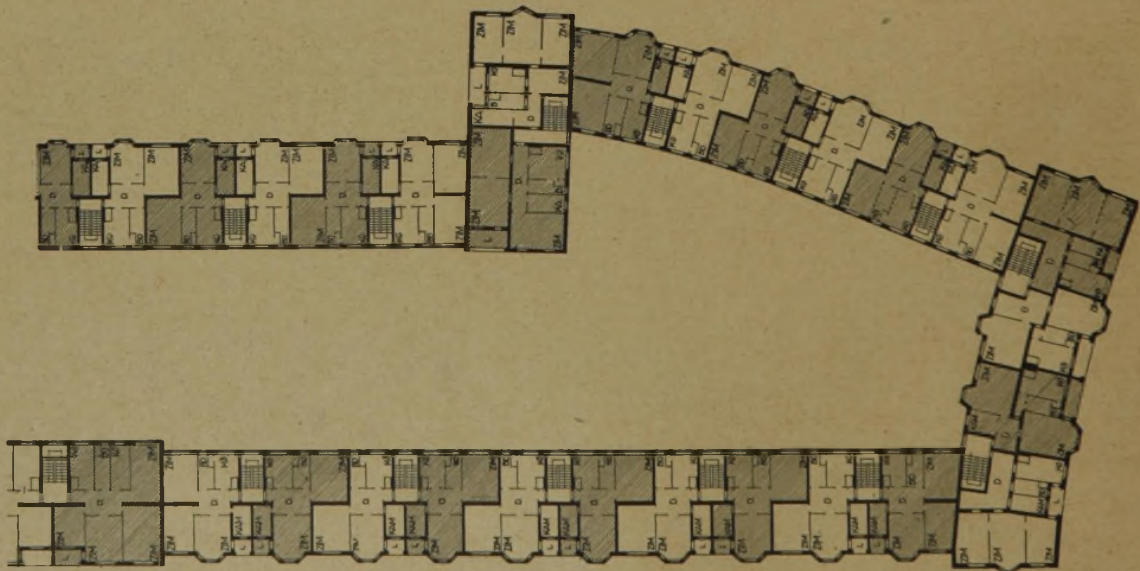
Wohnhausgruppe Schöneberg, Ceciliengärten. Grundriß des Obergeschosses. (1 : 800.)
